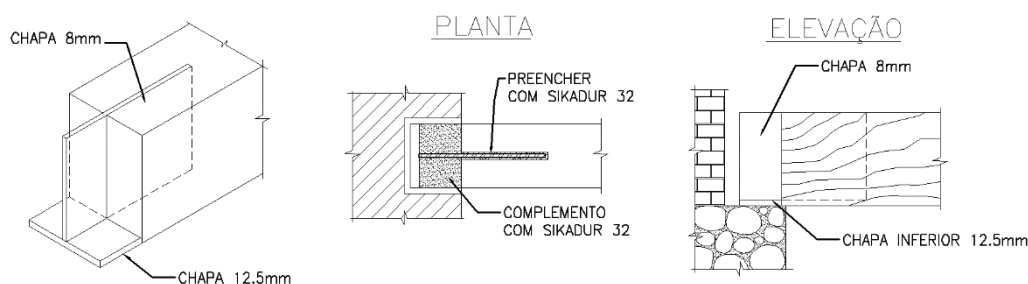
Solução estrutural recomendada para reparar a degradação do apoio das vigas de madeira de piso para o Museu Nacional da Quinta.
